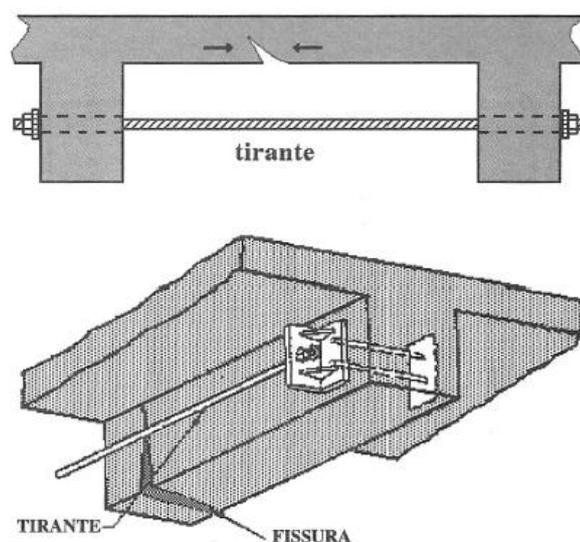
Costura de fissuras em viga de concreto através da protensão exterior.
